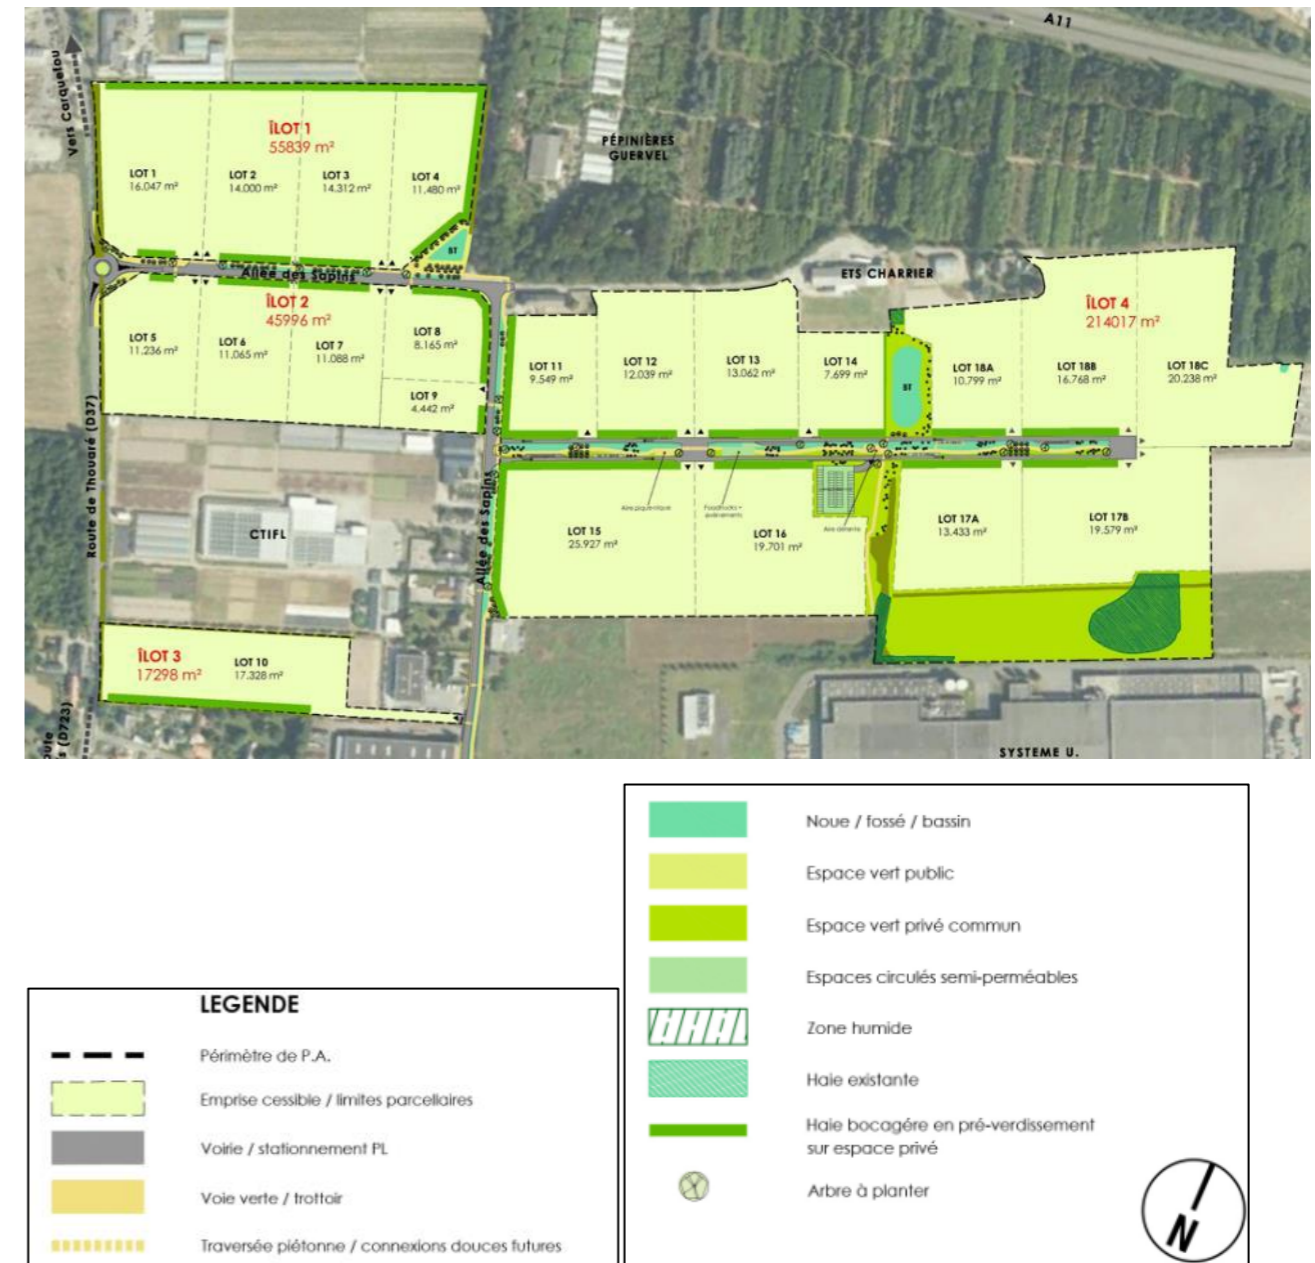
PLAN D'AMÉNAGEMENT DE LA VARIANTE 1
